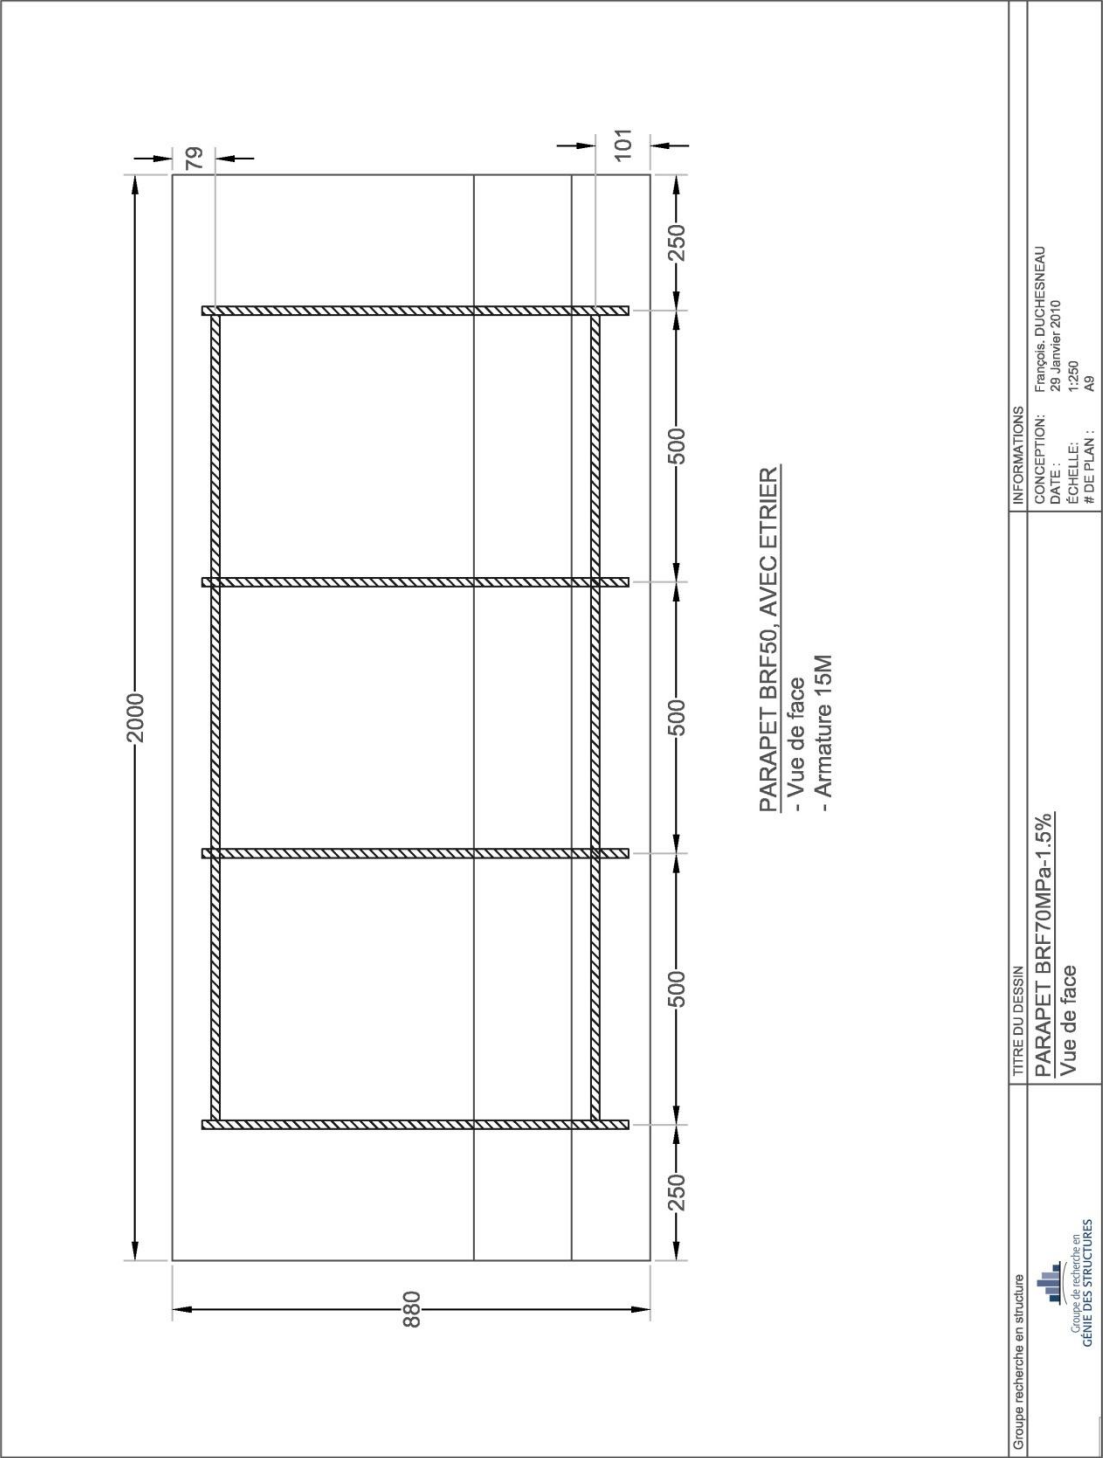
Plan de face du parapet BRF70MPa-1.5%
